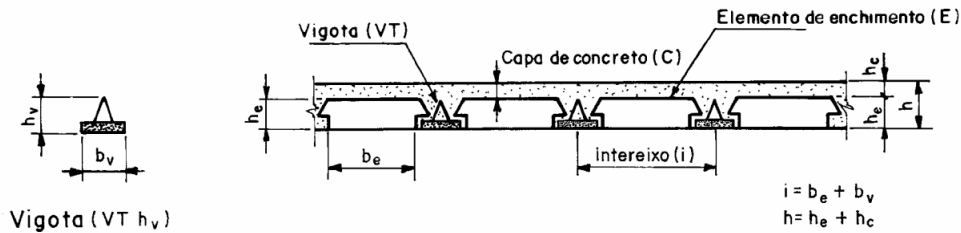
Dimensões principais das lajes pré-moldadas – NBR 14859-1:2002
